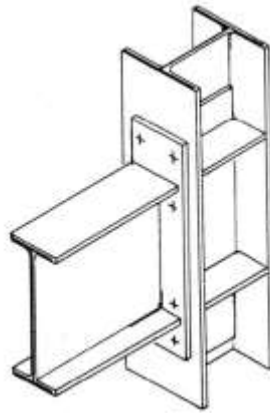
Ejemplo ilustrativo del diseño de una conexión viga-columna con placa tope. ([www.detallesconstructivos.net](http://www.detallesconstructivos.net))
